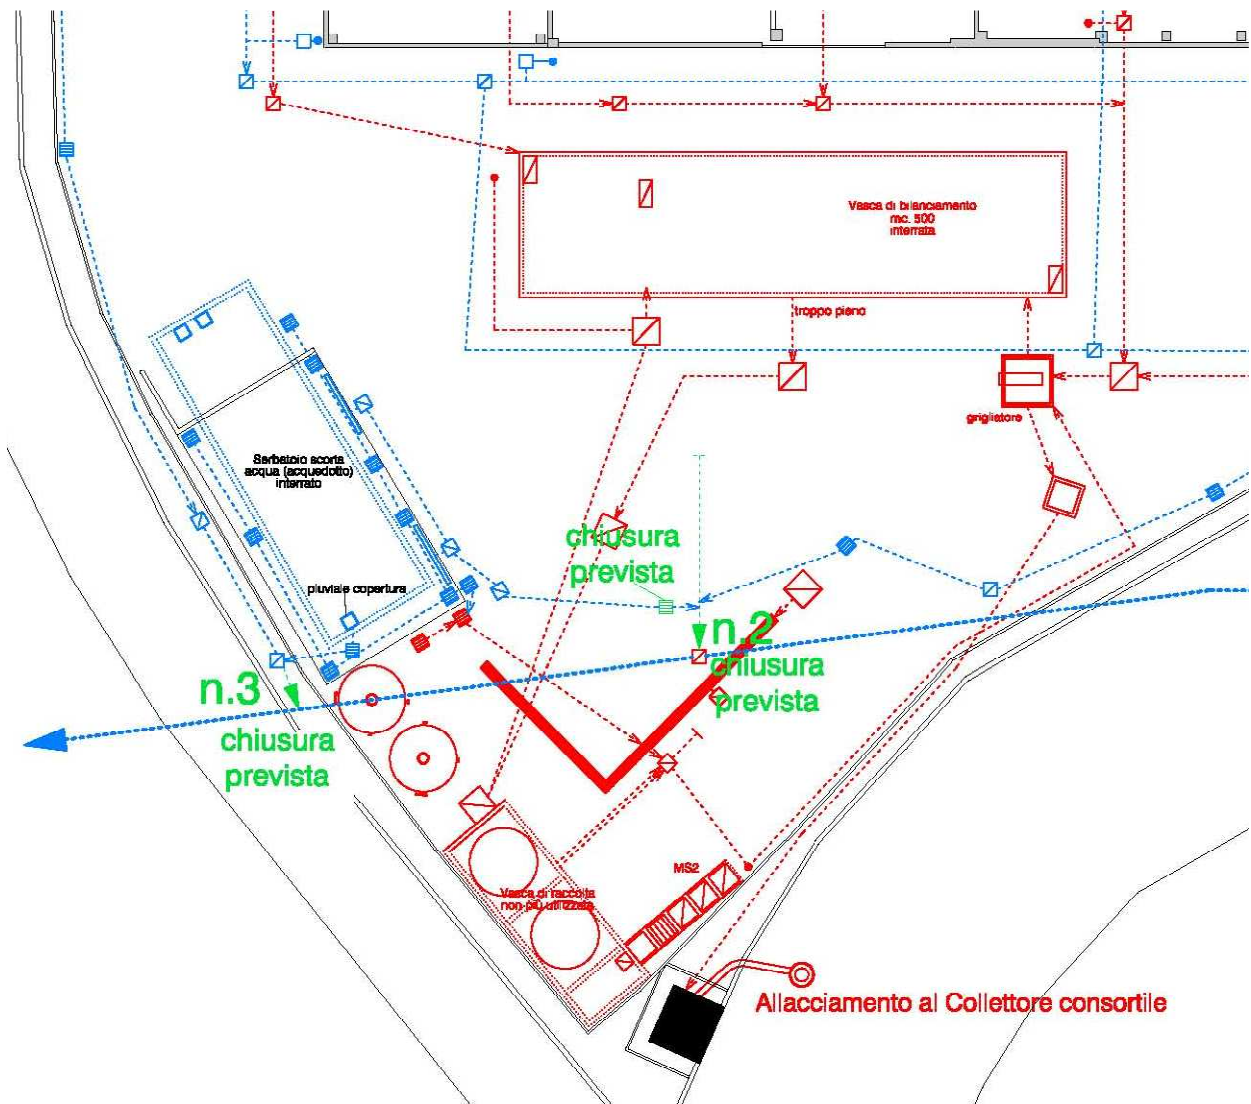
Schema planimetrico dell'area in esame, sono indicate in verde le modifiche previste
